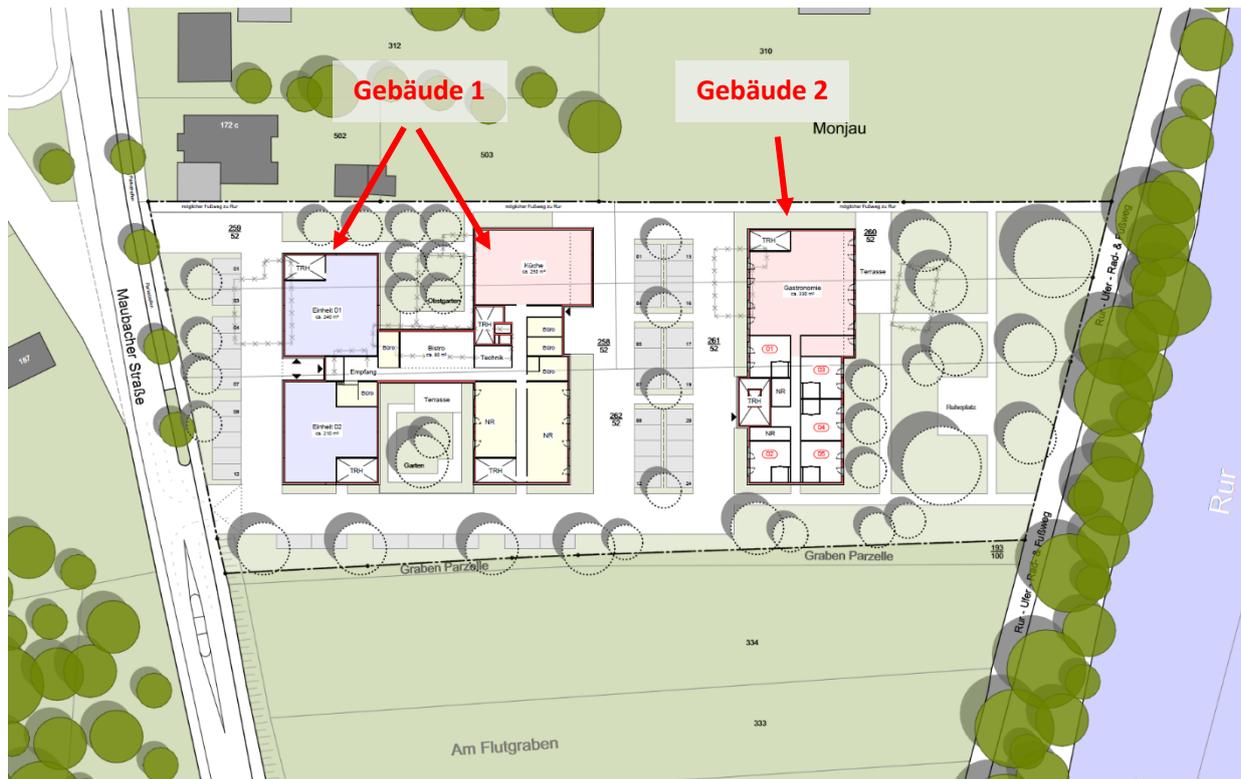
Übersichtsplan erster Planentwurf Erdgeschosssebene (Haid Architekten, Stand 28.01.2021)
